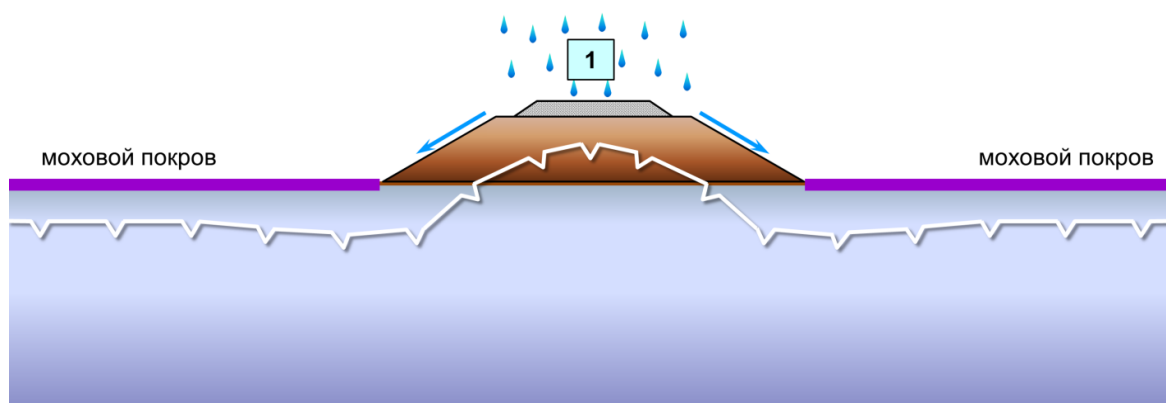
Схема отепляющего воздействия атмосферных осадков для насыпи из недренирующего грунта:
